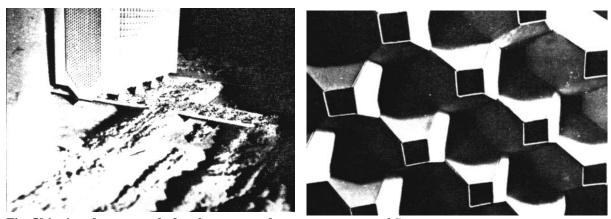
vista da empena da face leste que se descarrega contra o chão. Fig. 595: vista dos elementos pré-fabricados em concreto armado, existentes nas faces leste e oeste.
